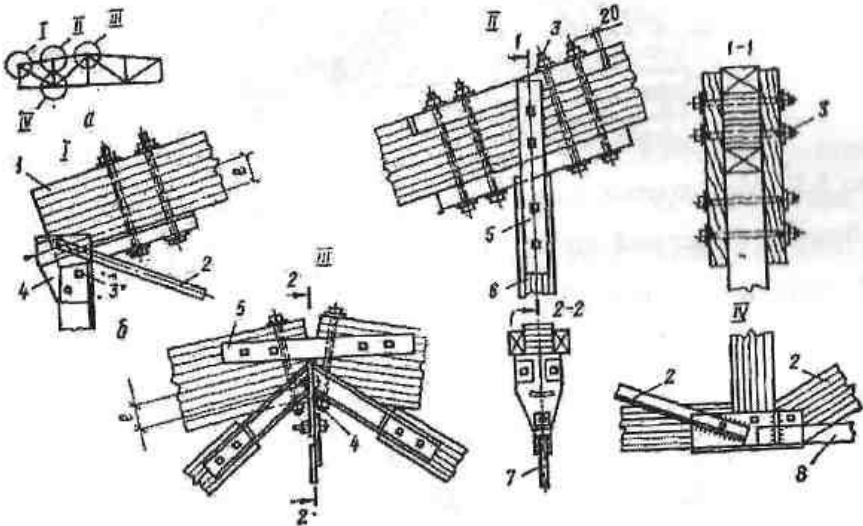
Металодерев'яна ферма з верхнім клеєним поясом: а – схема ферми; б – вузли; 1 – верхній пояс; 2 – кісець; 3 – болти; 4 – сталеві елементи вузлів; 5 – накладки; 6 – стояк; 7 – підвіска; 8 – нижній пояс
